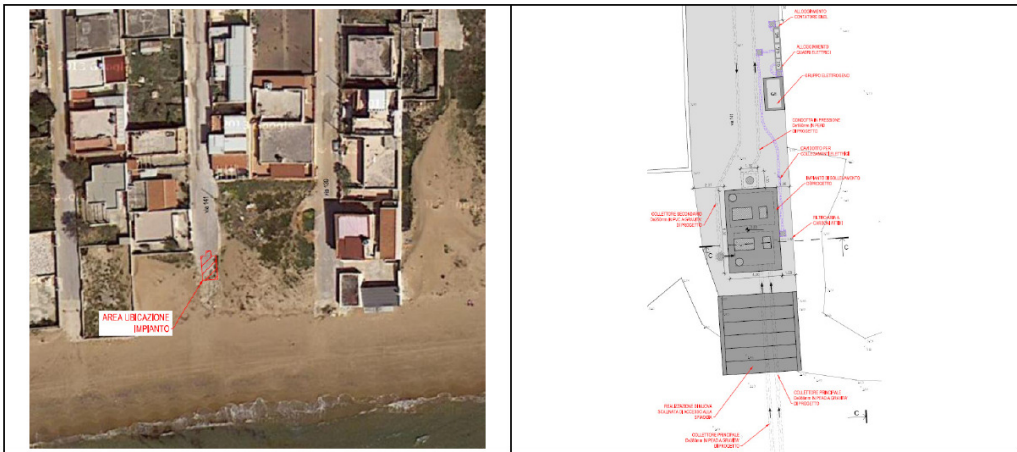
Area di ubicazione dell'impianto di sollevamento S9
